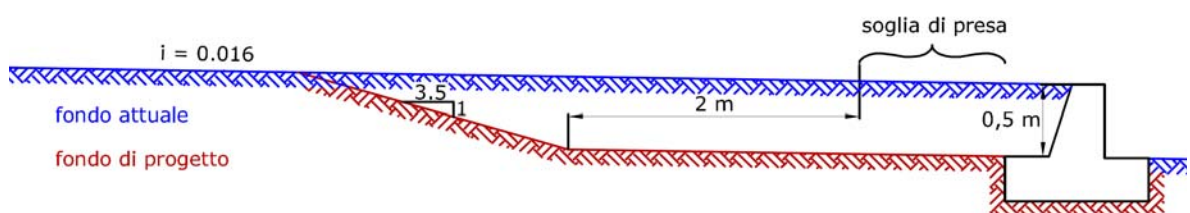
Profilo attuale e di progetto del fondo in corrispondenza della sezione di presa
